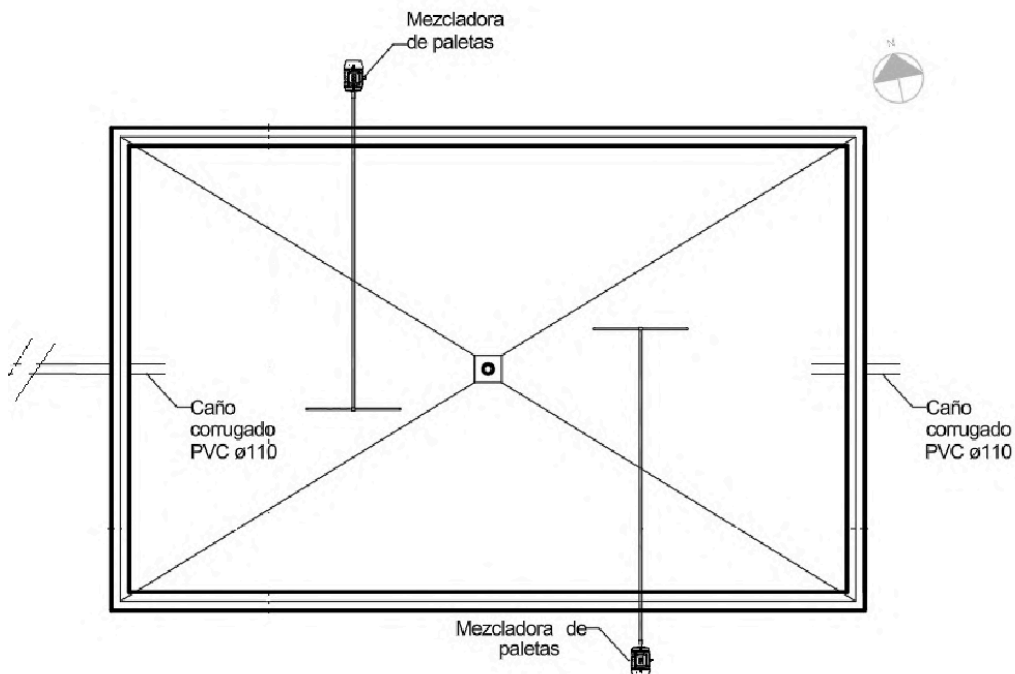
disposición de los mezcladores en planta. Fuente: elaboración propia.
